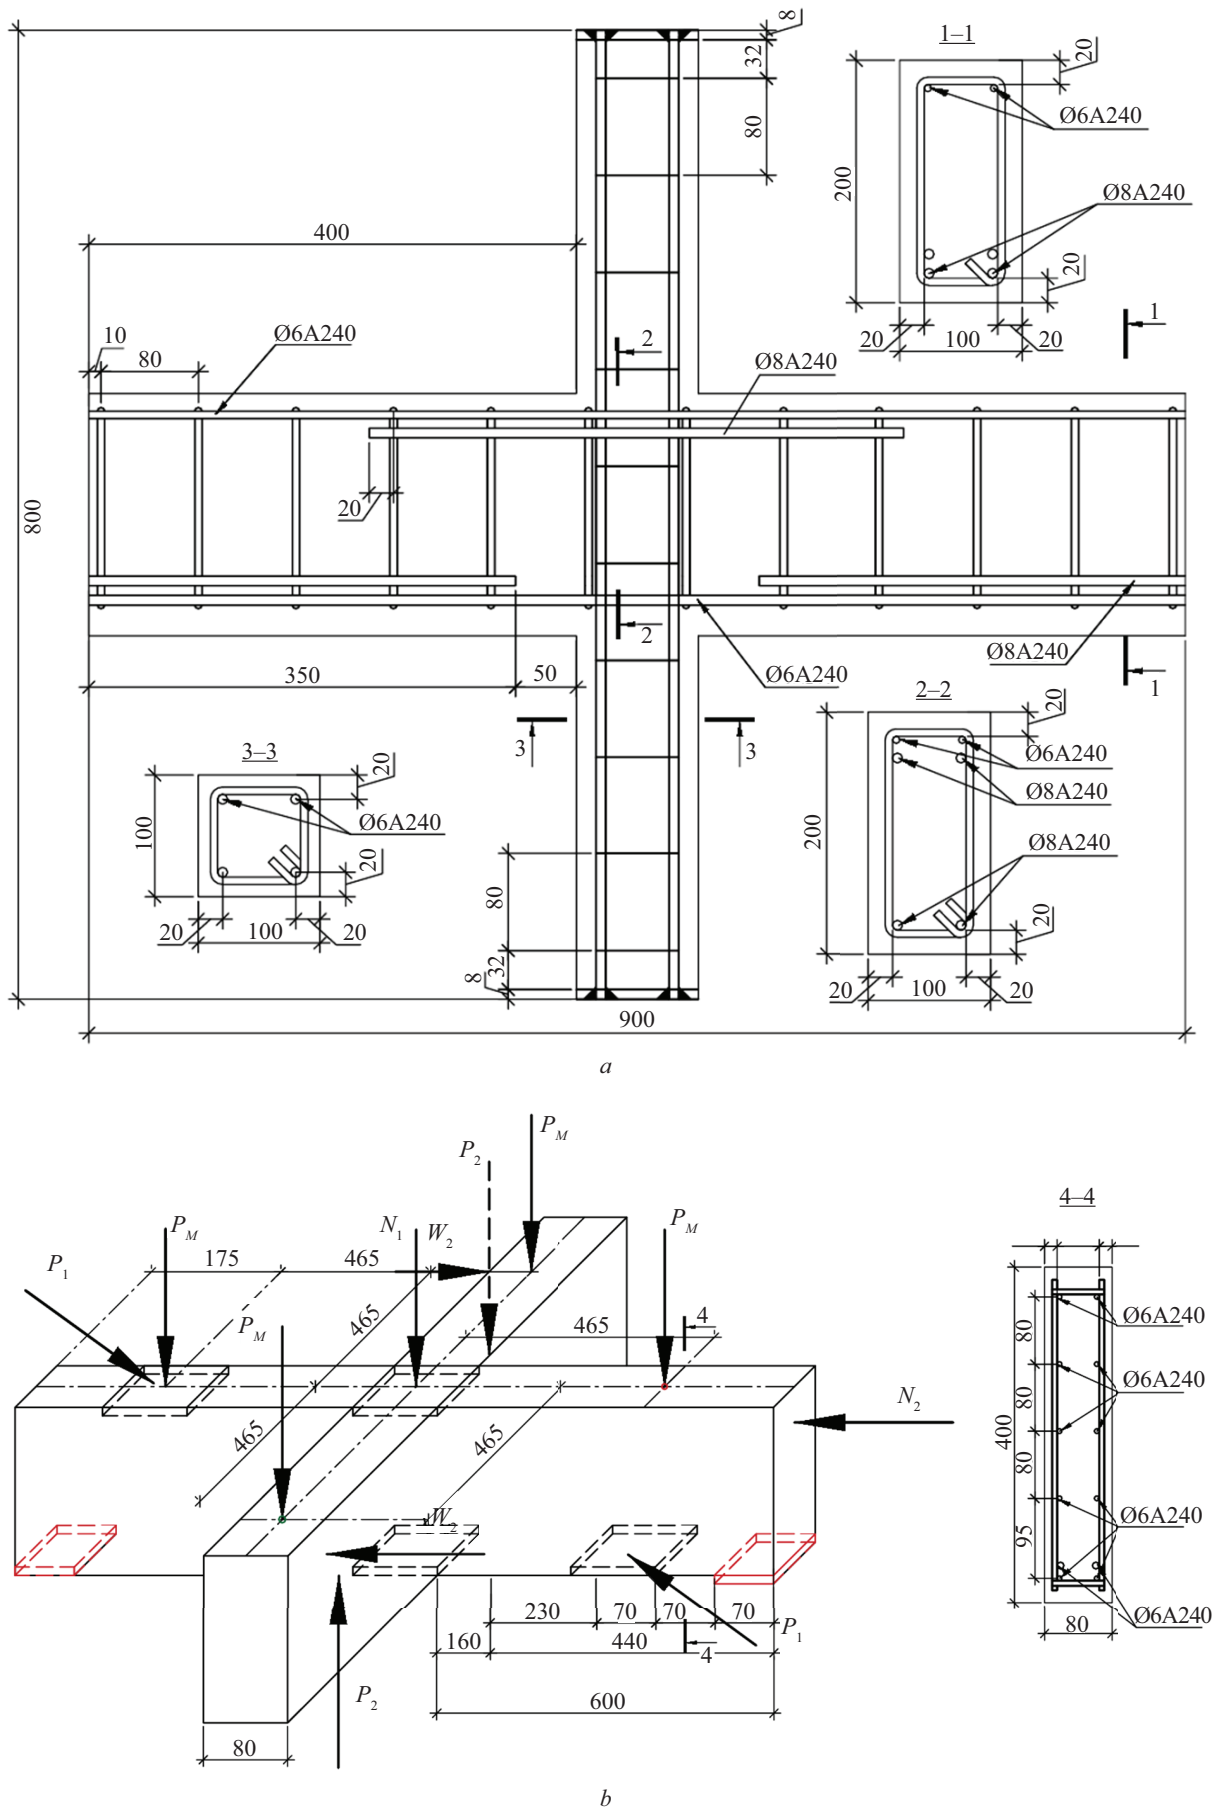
Общий вид конструкций крестообразных узлов (а) и стен (b)
